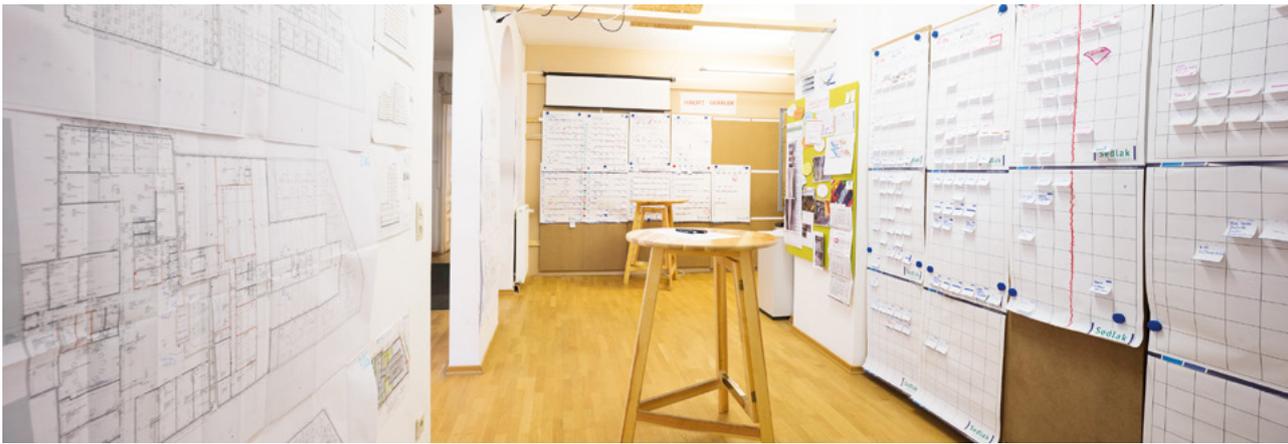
Der Big Room im gemeinsamen Baubüro
